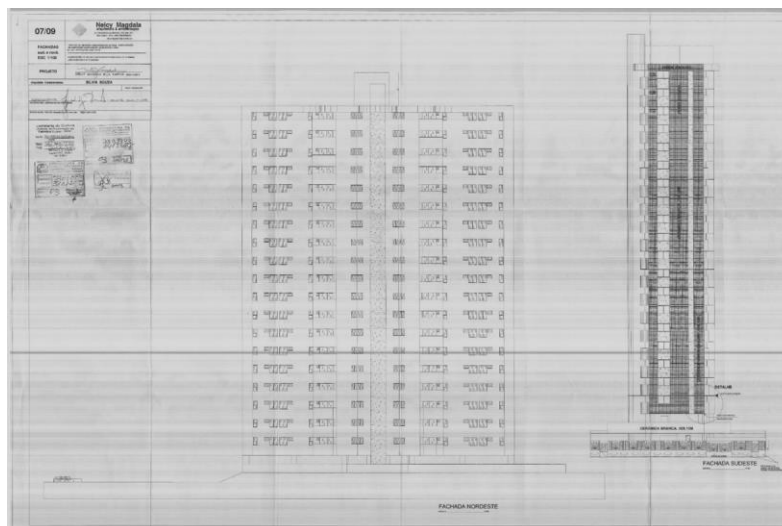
Fachada do Edifício Praça de Casa Forte. Fonte: Arquivo da Prefeitura de Recife (2006).
